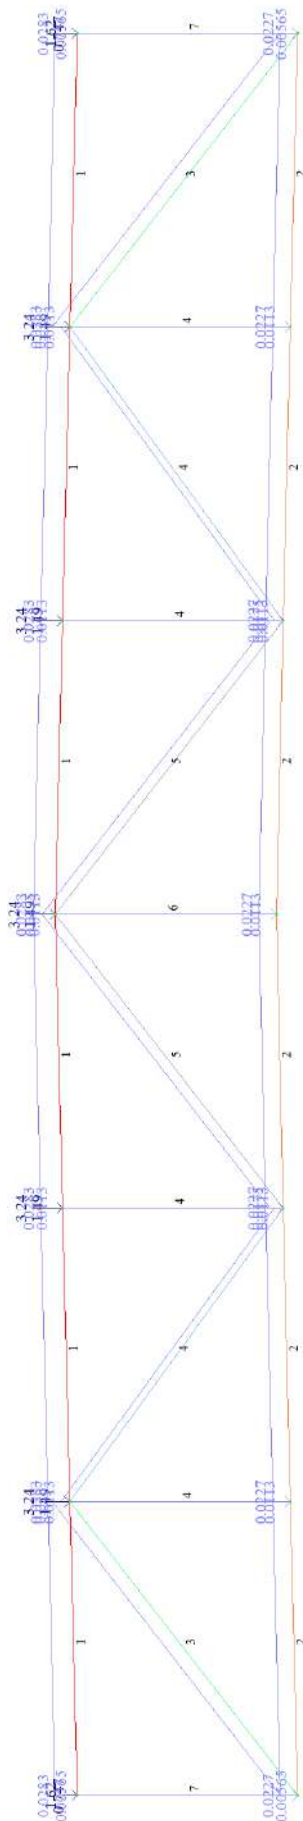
Графическое отображение нагрузок на ферму
